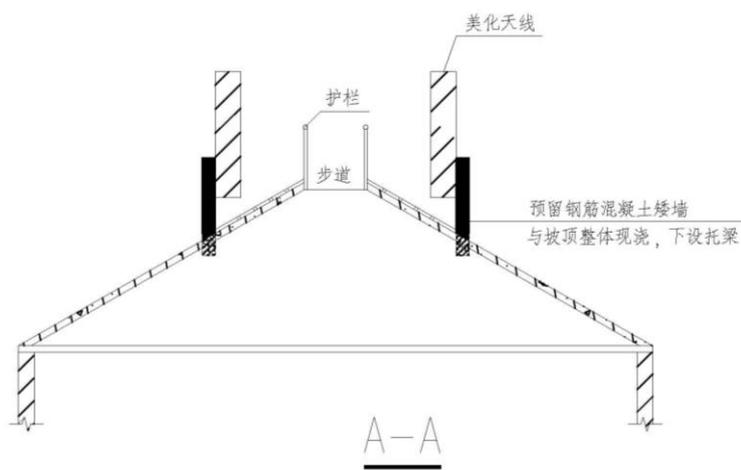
无突出屋面楼梯间、电梯间、设备用房的坡屋面设施布置示意图
